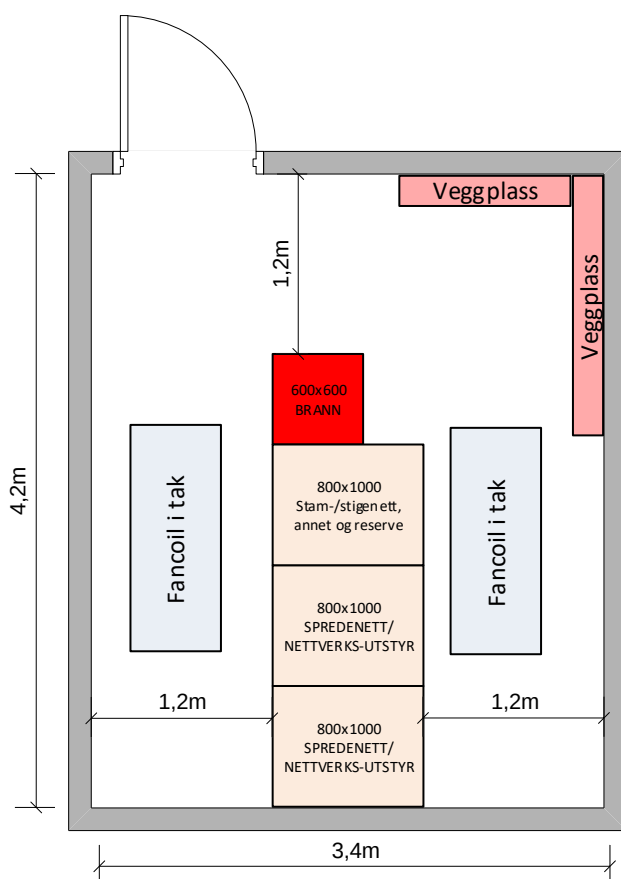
FORESLÅTT CA. PLASSERING PLAN 03-04
